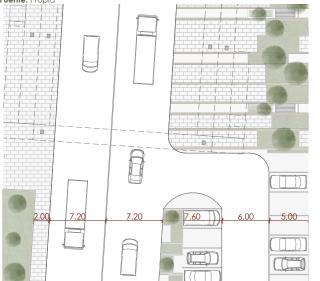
Planta de reestructuración de vía rápida Biblián-Azogues Fuente: Propia
